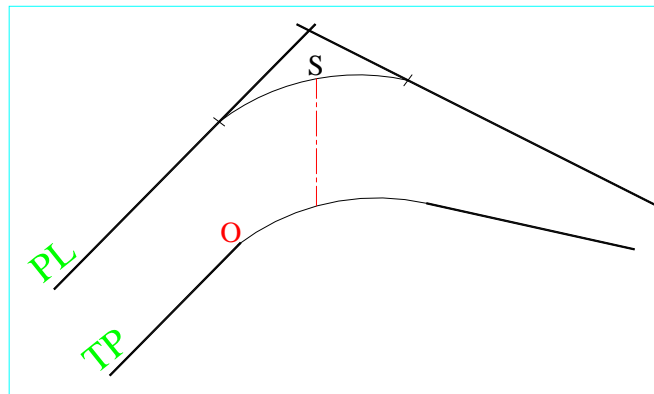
COORDINATION DU PROFIL EN LONG ET TRACÉ EN PLAN
